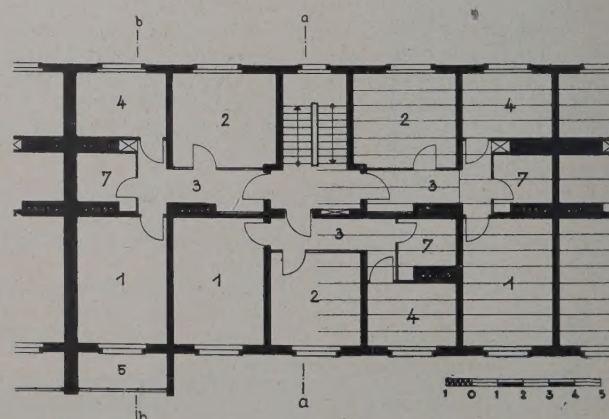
Obergeschoßgrundriß mit drei Zweizimmerwohnungen
